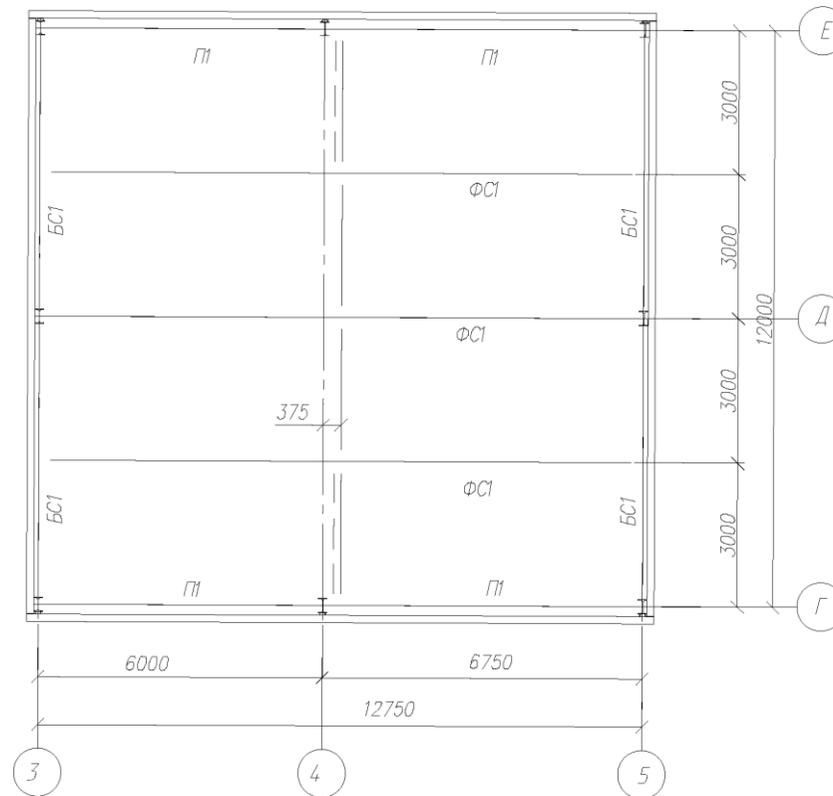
Схема расположения стропильных ферм и балок покрытия на отм. +9,635
